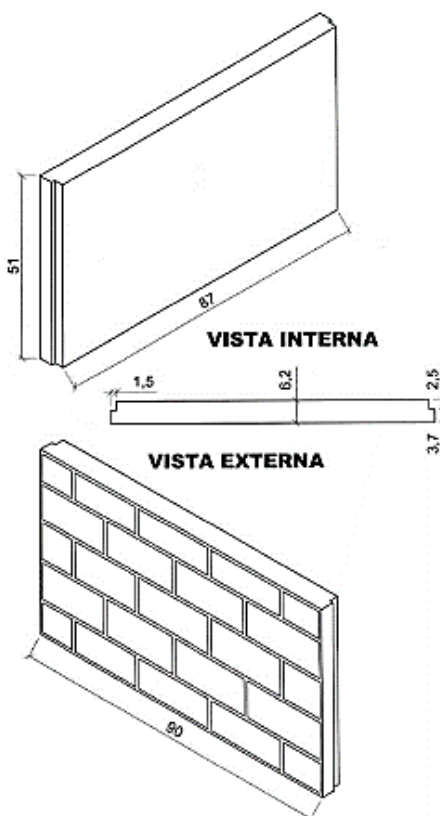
Painel de vedação sem função estrutural pré-fabricado em concreto com adição de microfibras de polipropileno.
